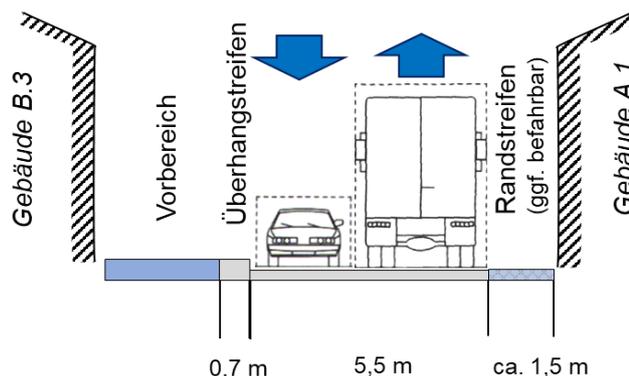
Entwurf Querschnitt Planstraße (nördlicher Teilbereich)
